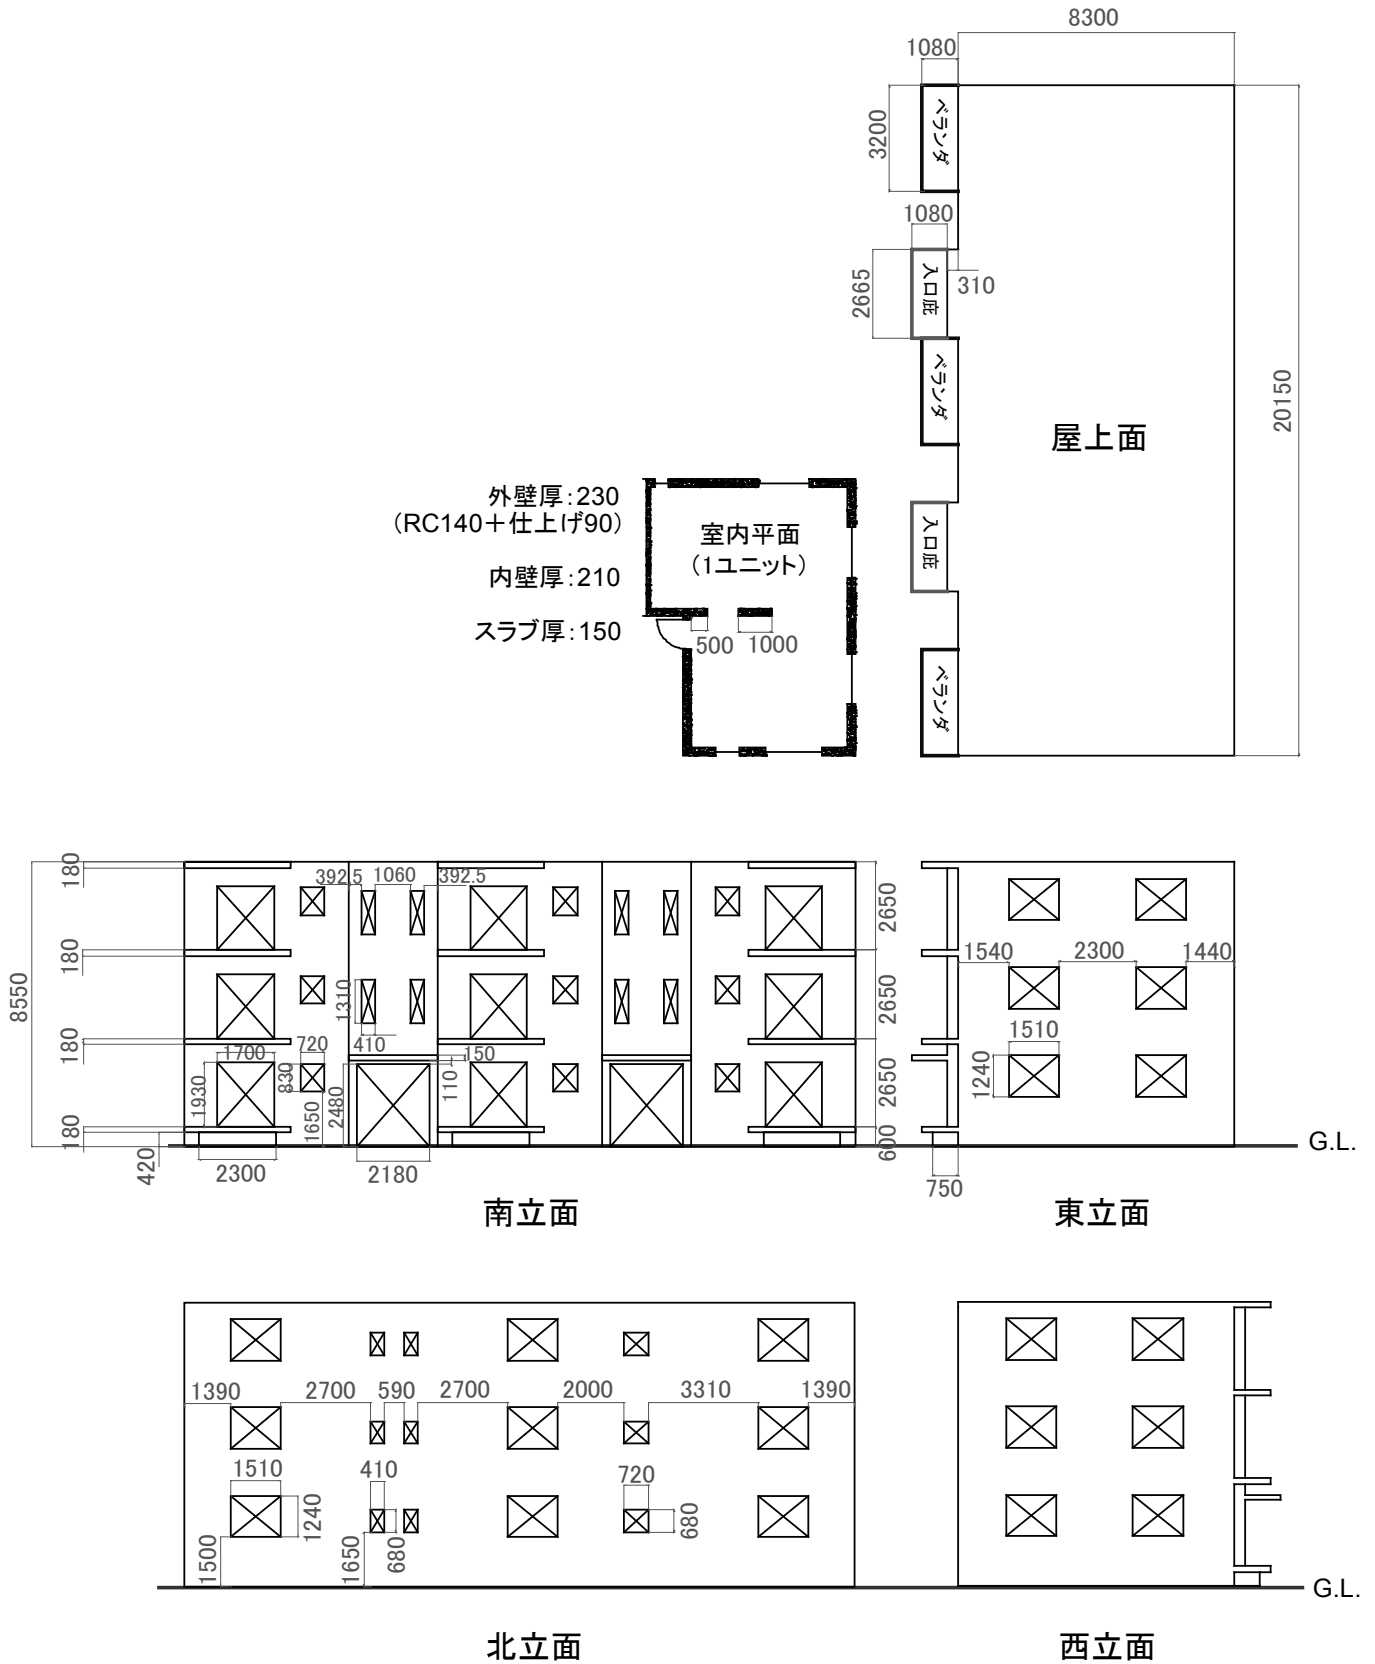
P.F の立面図・平面図 (単位 : mm)
